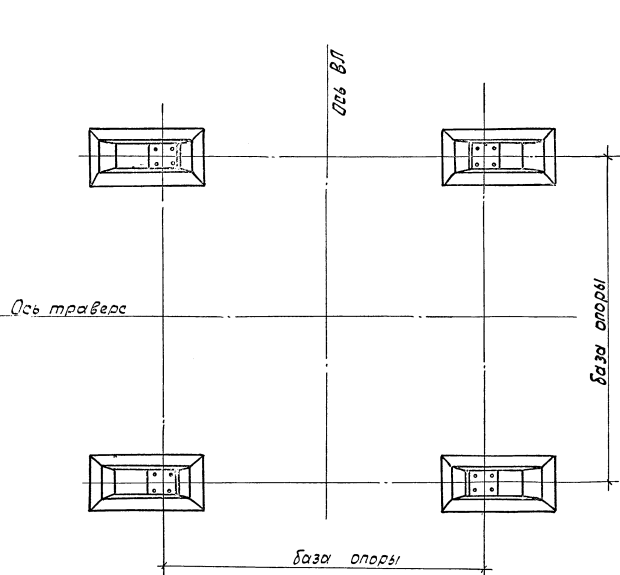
Конструкции унифицированных железобетонных элементов фундаментов
